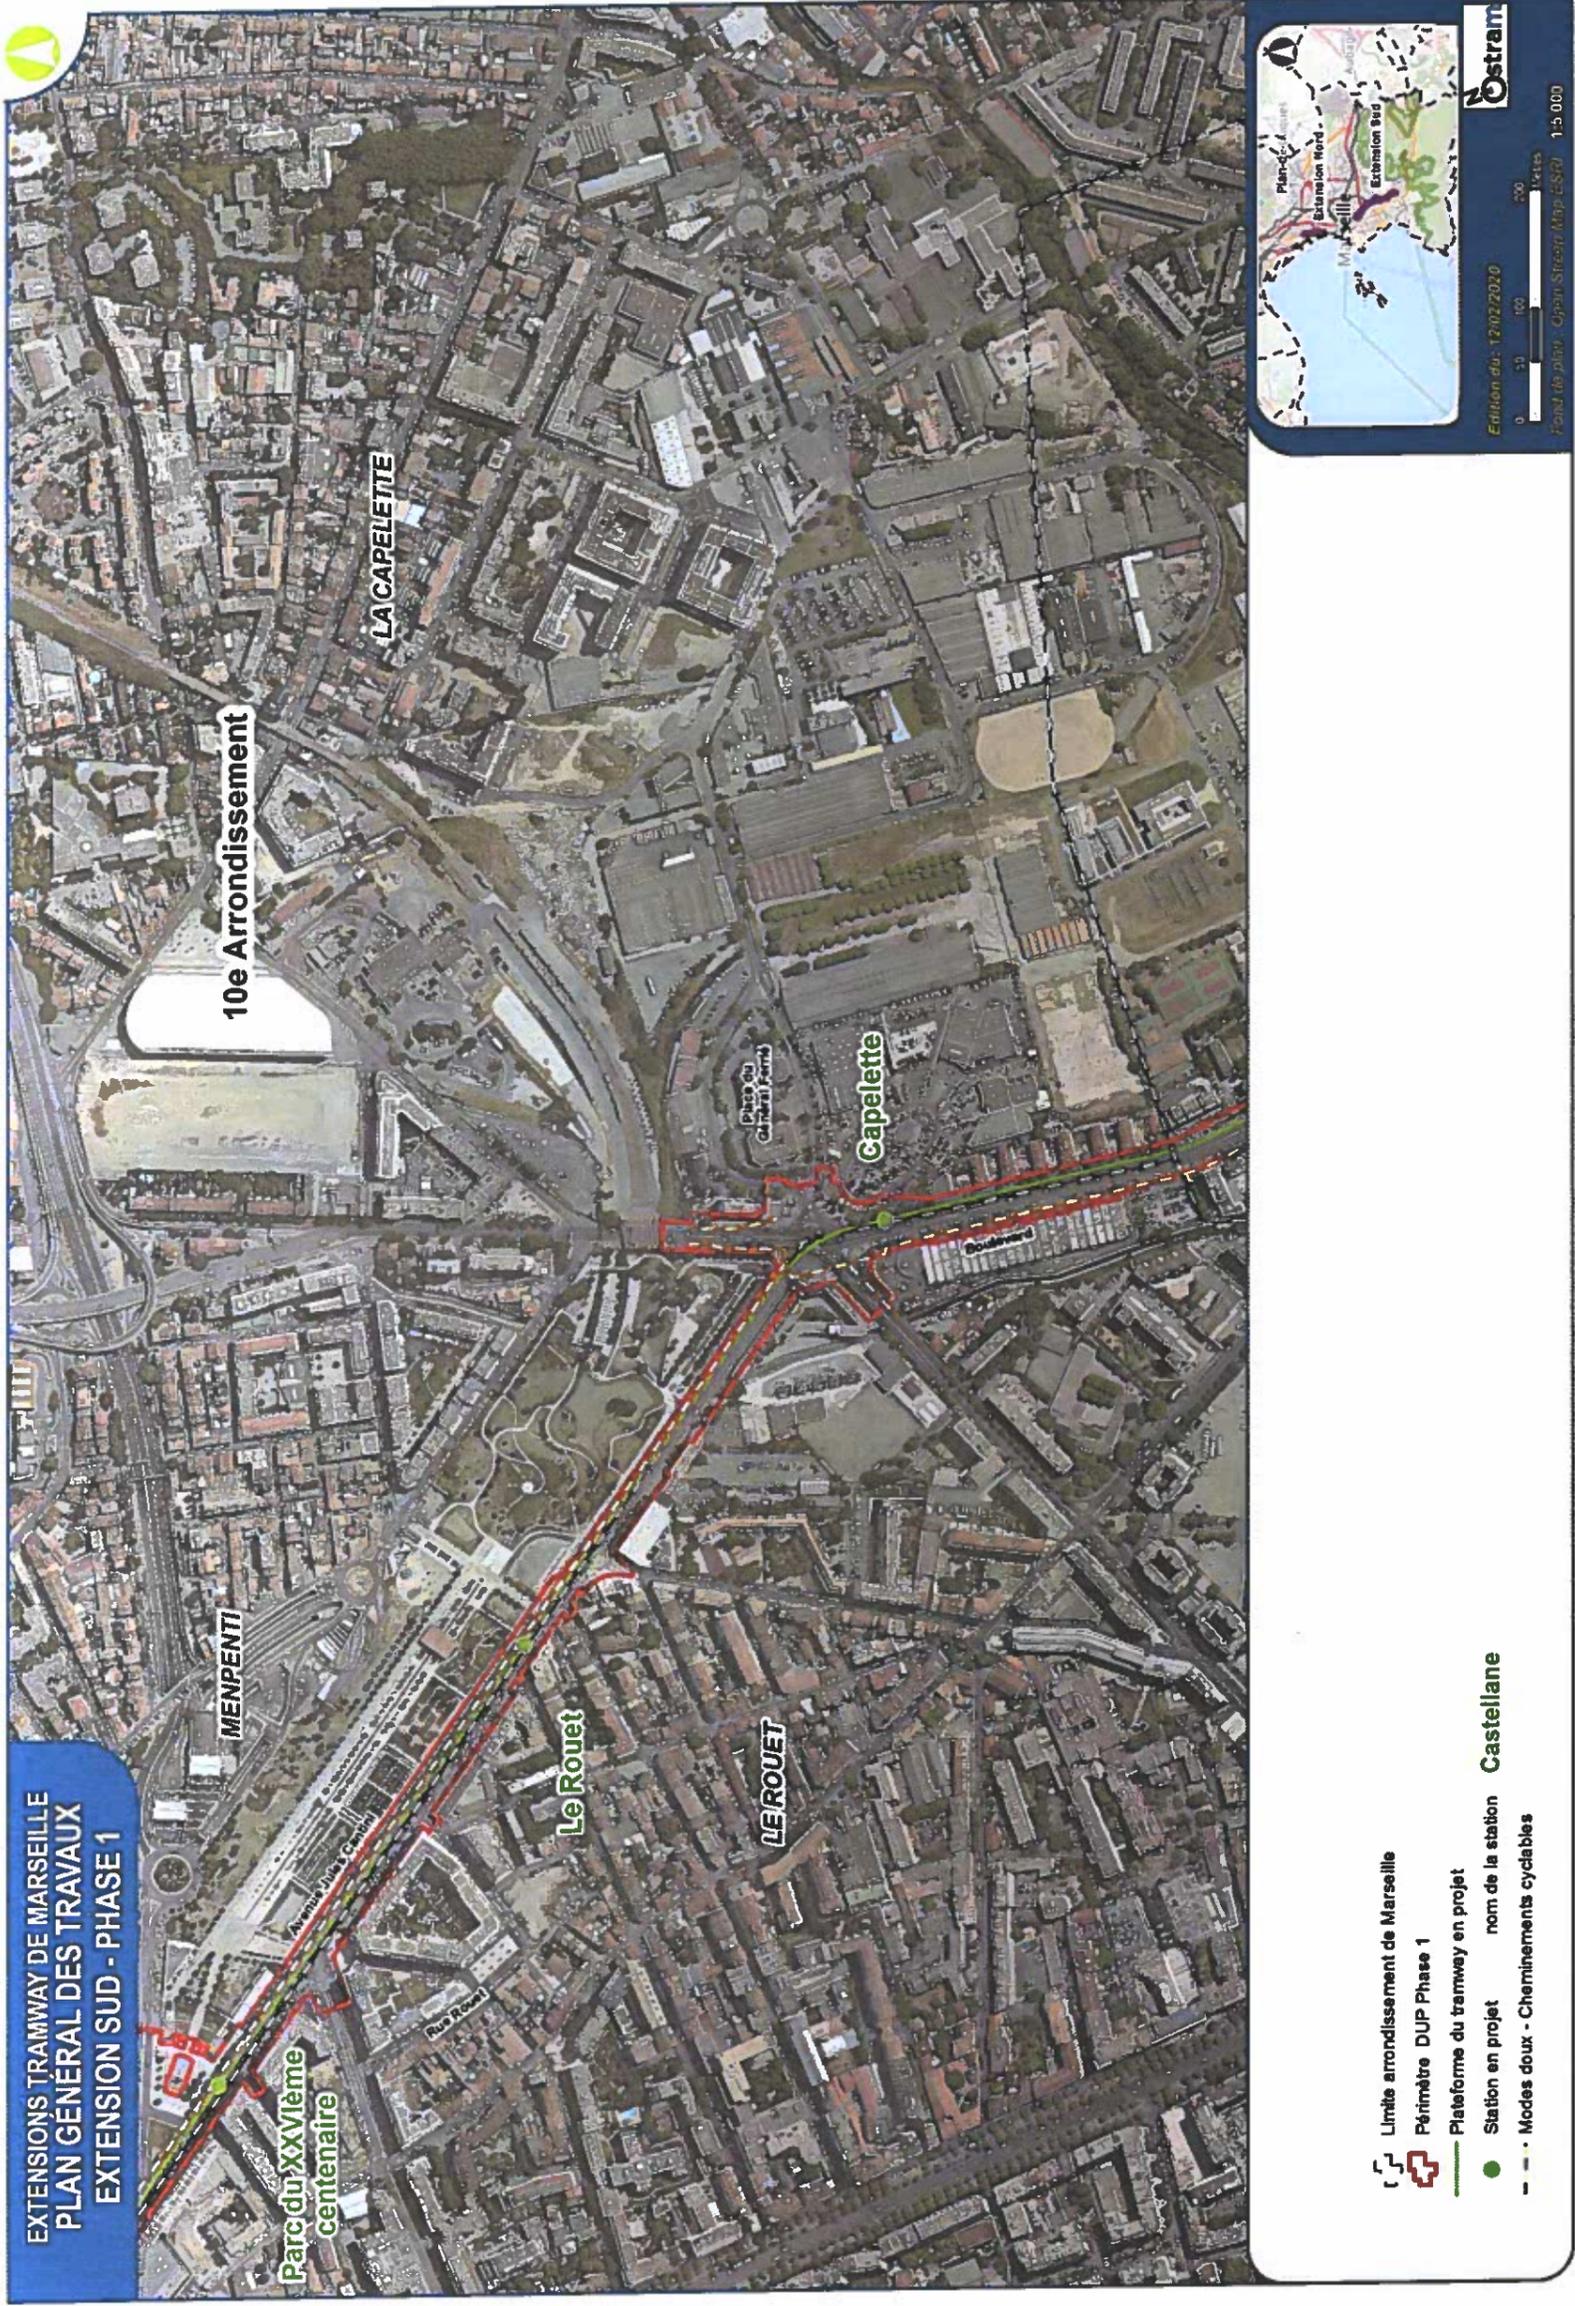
Plan Général des Travaux - Extension Sud (planche 2/5)
